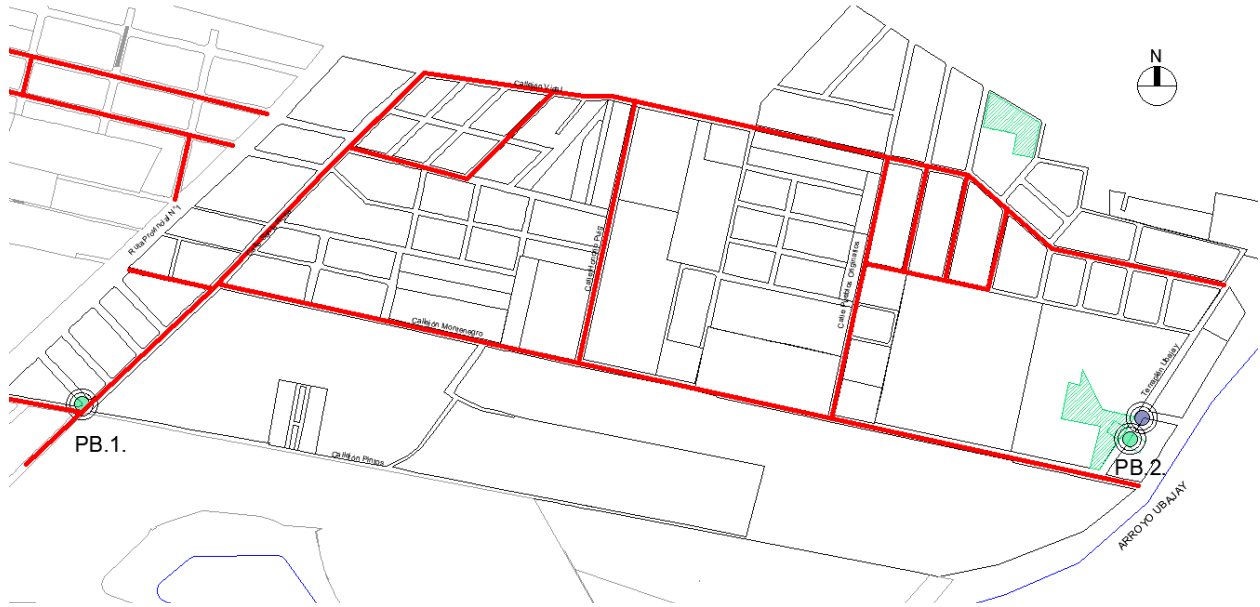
Plan de mantenimiento de calzadas y canales. Planimetría realizada por la Municipalidad de San José del Rincón.
